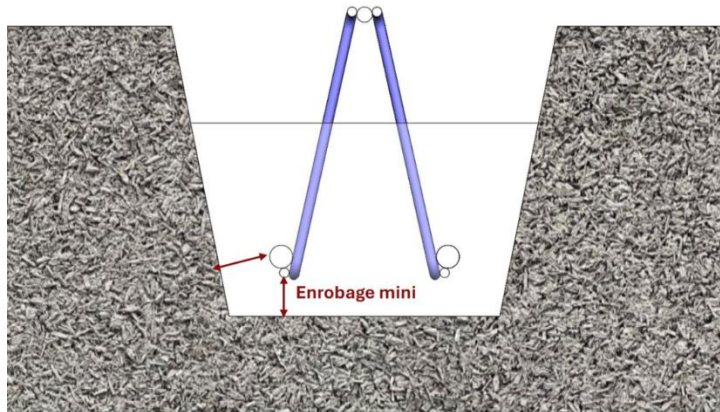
Coupe - Enrobage minimum des armatures des poutrelles
